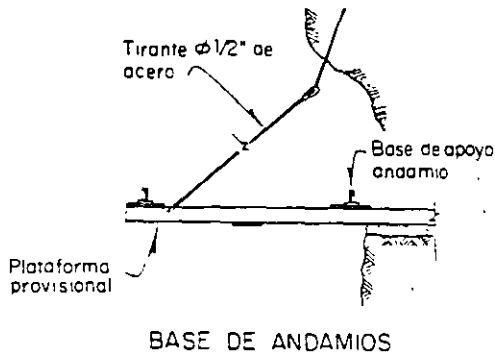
Proceso constructivo de galerías para traves de anclaje
